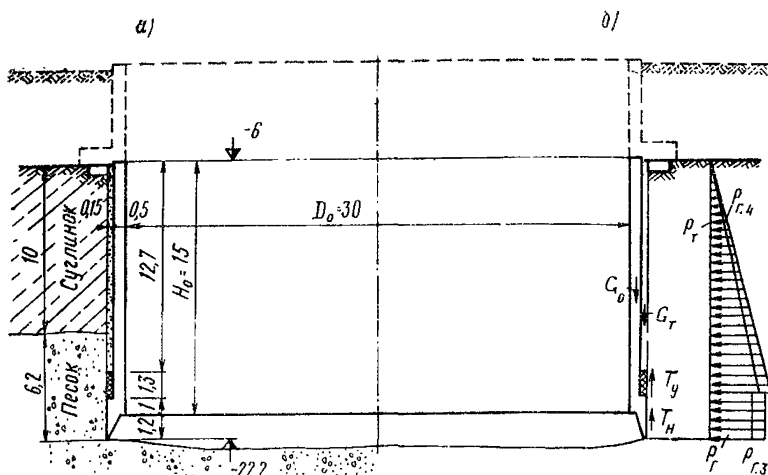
Схема круглого колодца (а) с расчетными нагрузками (б) в условиях погружения с разработкой грунта посуху
